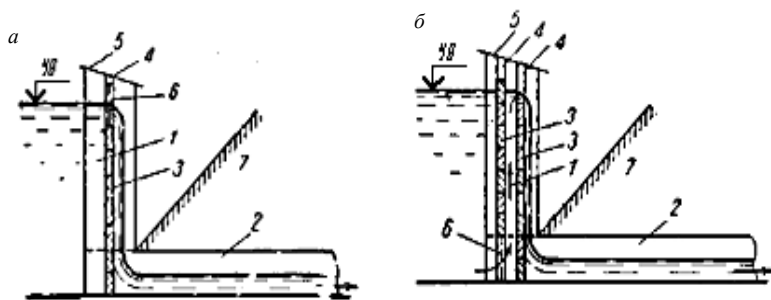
Схематические разрезы стояков с одним (а) и двумя (б) рядами щитков: 1 – стояк; 2 – лежак; 3 – щитки; 4 – пазы для щитков; 5 – крышка; 6 – рамка с сеткой; 7 – дамба
